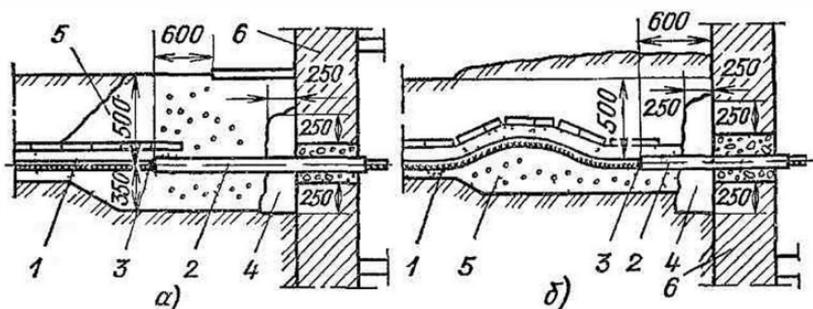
Ввод кабеля через трубу в здания или кабельные сооружения: а — при отсутствии просадок грунта, б — при оживлении просадки грунта, 1 — кабель, 2 — труба, 3 — уплотнение, 4 — гидроизоляция, 5 — песок без примесей глины и камней, 6 — стена здания
